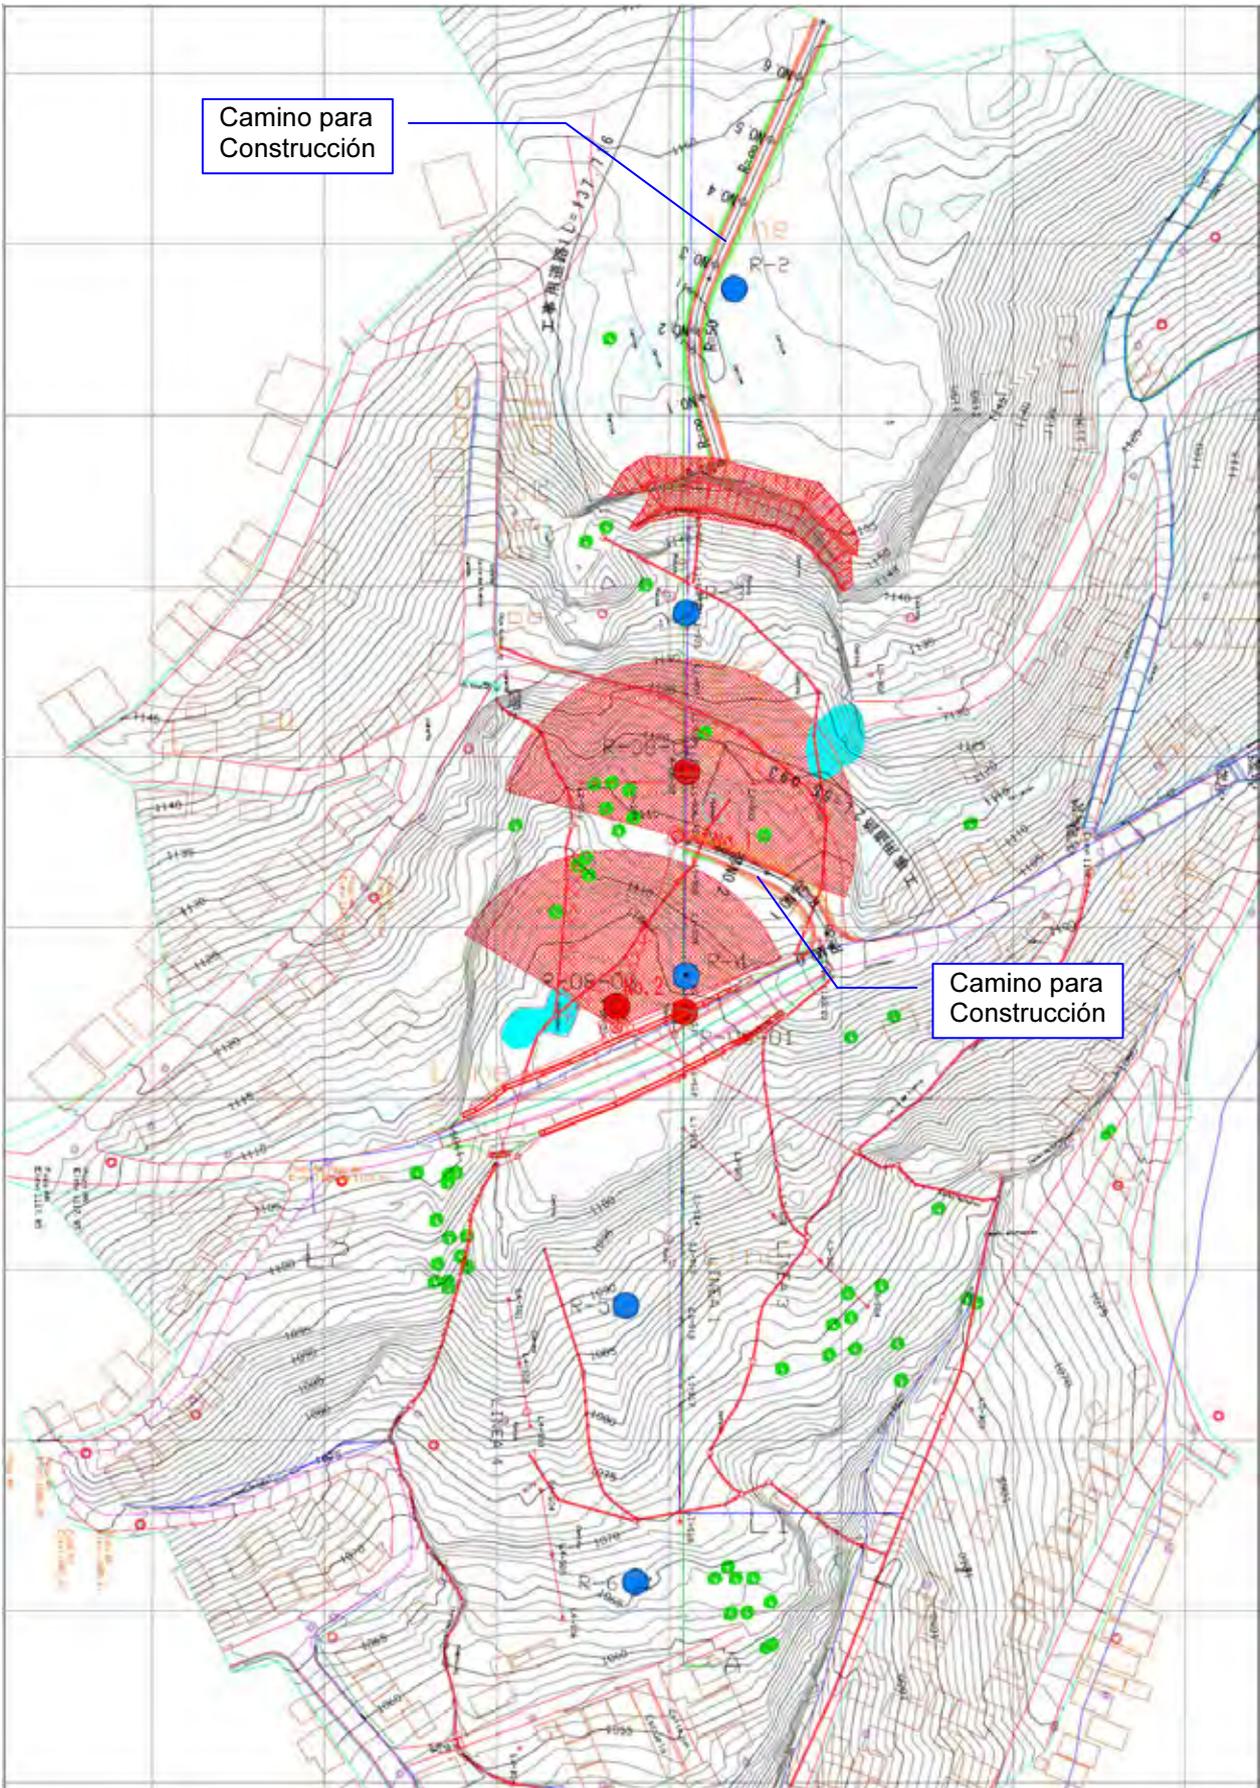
Vista en Planta del Camino para la Construcción (El Reparto)
